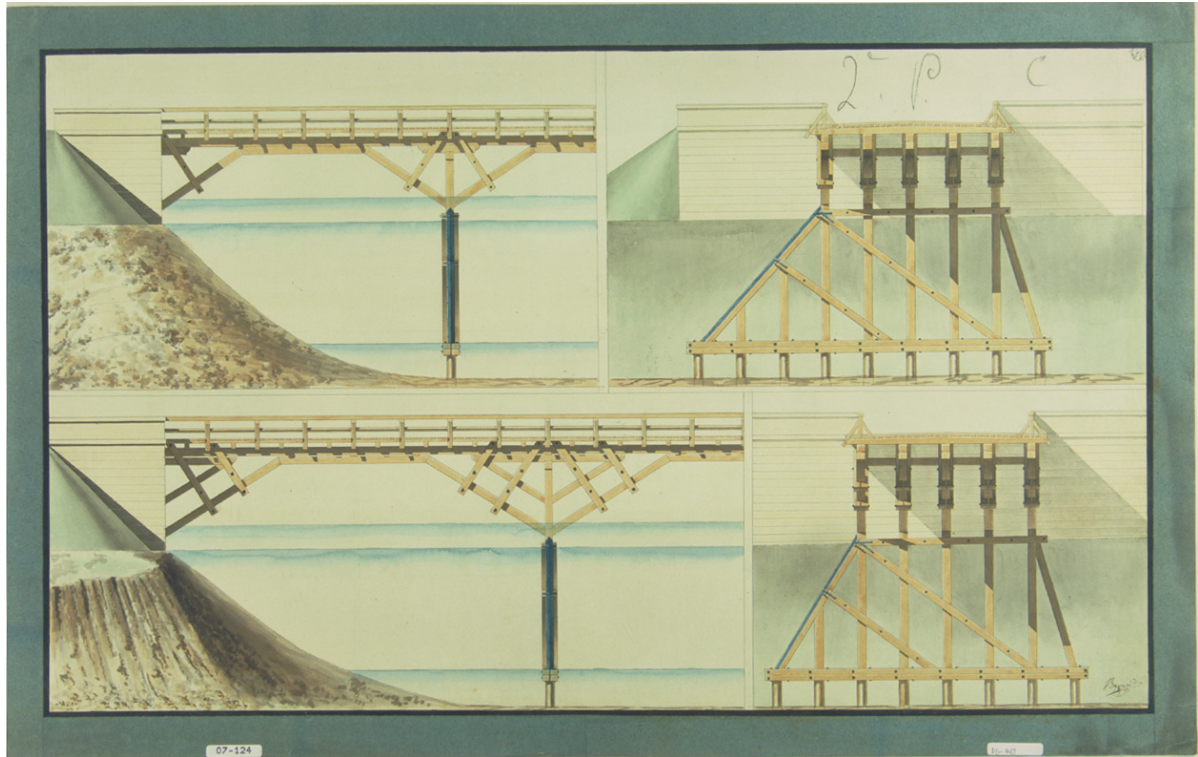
Ponte in legno. Prospetto e sezioni. © Collection École Nationale des Ponts et Chaussées. DG 461
